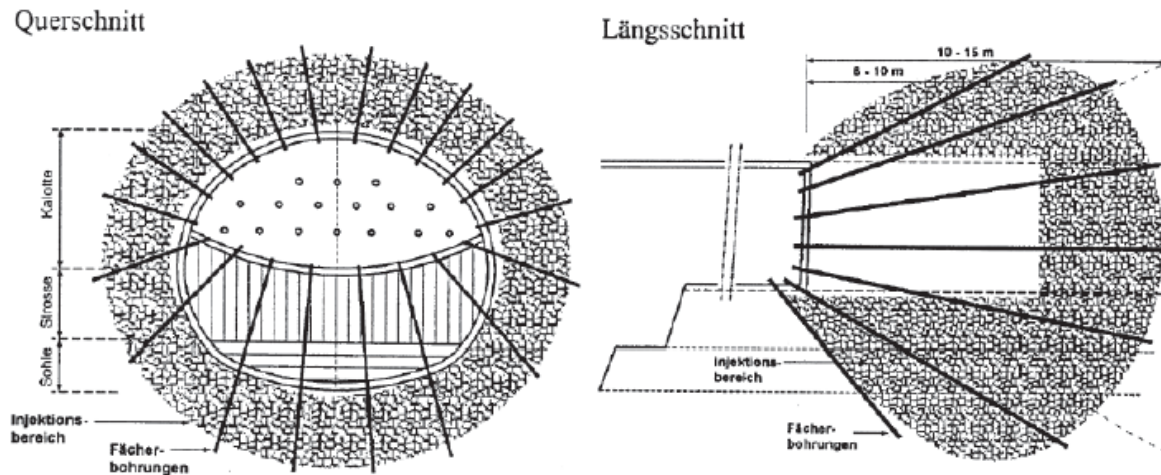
Injektionsschirm für Abdichtung (Girmscheid, 2008, S. 263)
